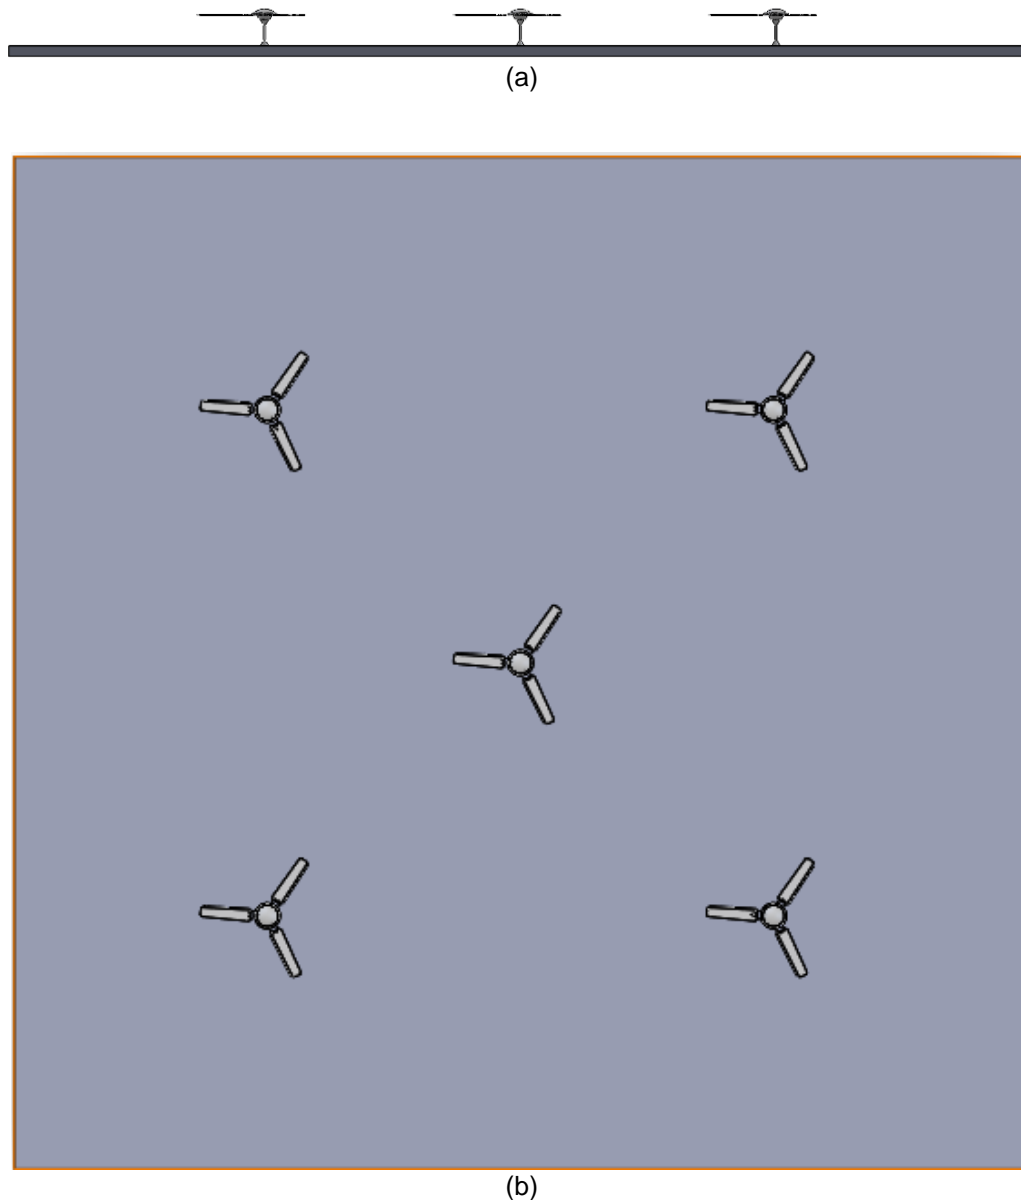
Vistas de la configuración con los ventiladores instalados en el techo: (a) alzado y (b) planta
